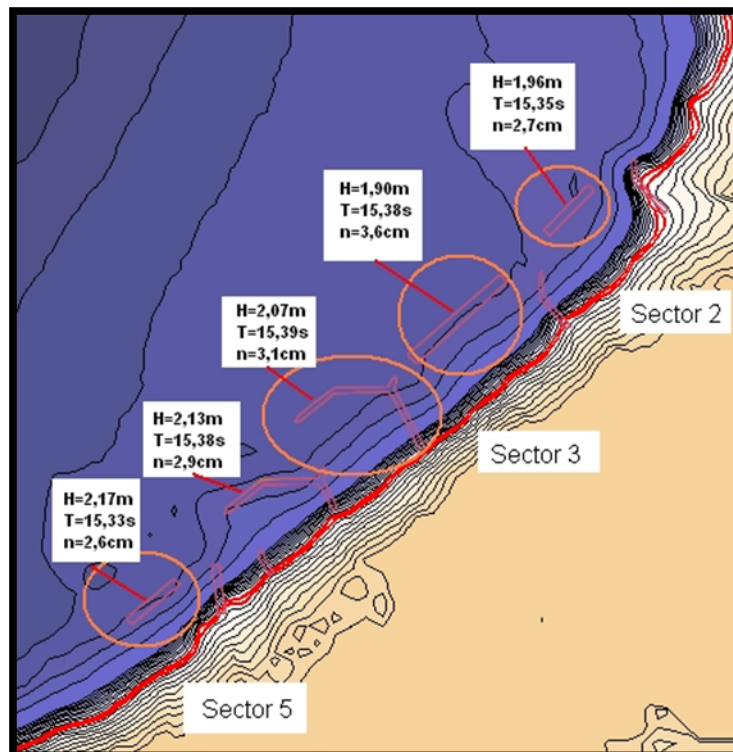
Esquema en planta con las obras actuales, obras propuestas y el oleaje incidente
